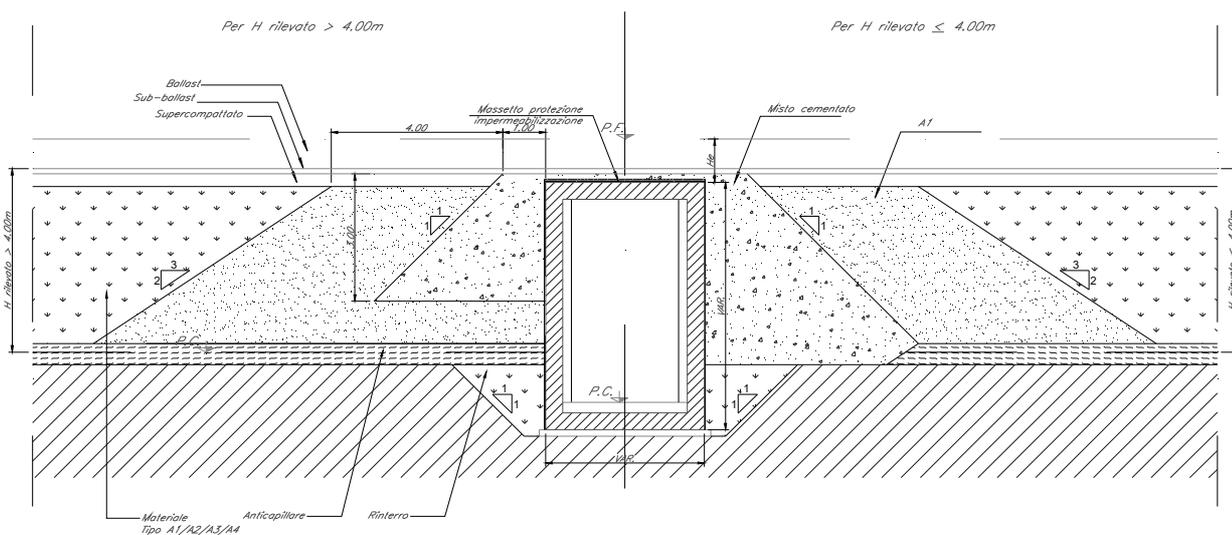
Zona di transizione rilevato-scatolare con $1,20 < H_e \leq 1,35$ m
